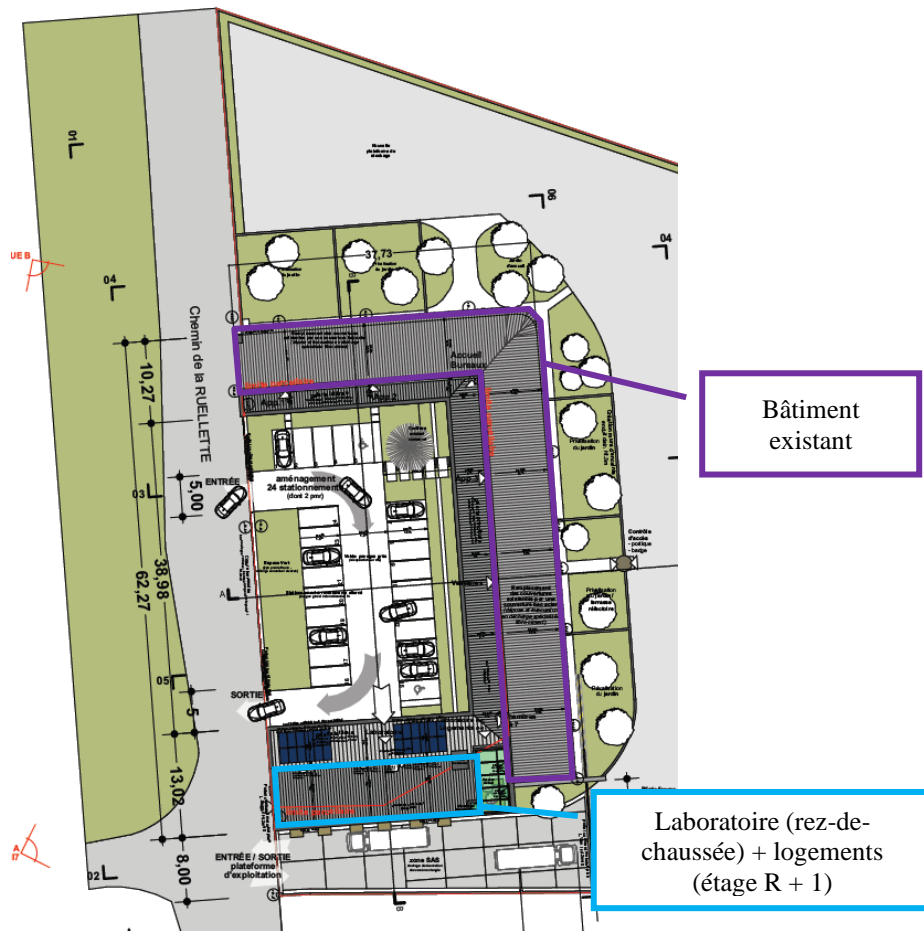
Plan de masse du Groupe Vessière à Longueil-Sainte-Marie – Localisation du futur laboratoire recherche et développement
